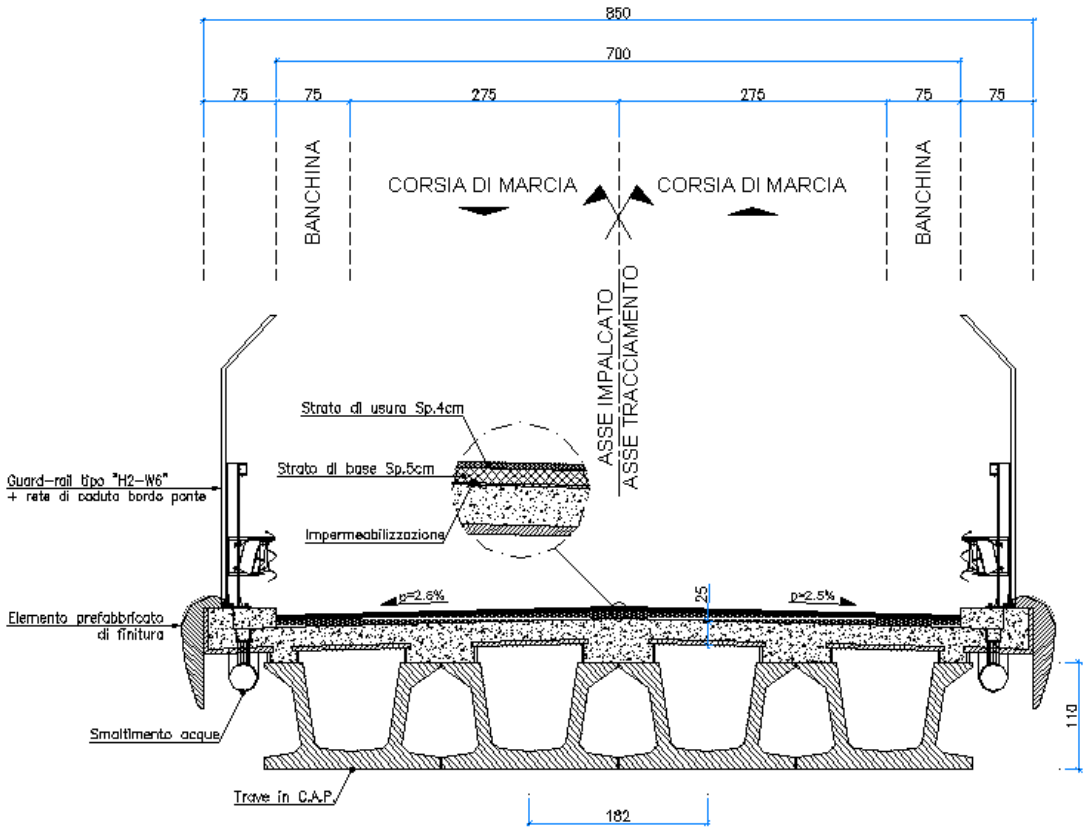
Sezione tipo (cavalcavia 1)
